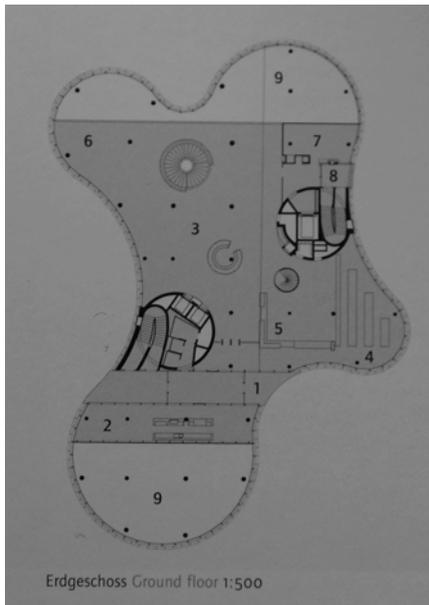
IKMZ Cottbus, Grundriss Erdgeschoss (aus: Architektur + Wettbewerbe (2007) S. 26)
